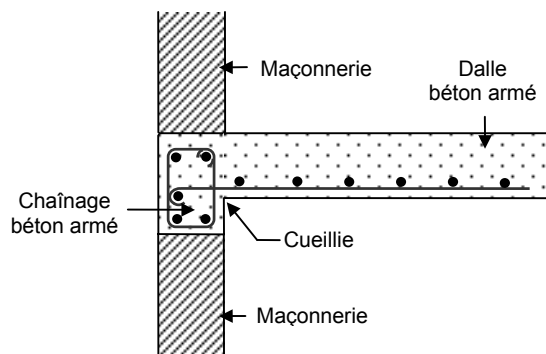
Plancher dalle pleine et chaînage de mur.
